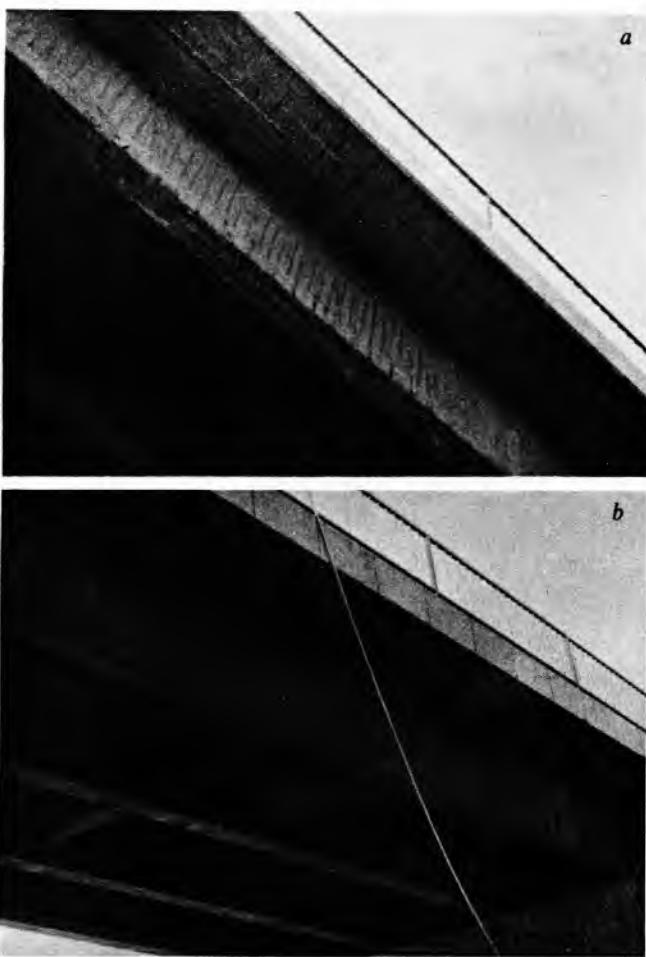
Zamjena nekvalitetnog betona ponovnim betoniranjem
